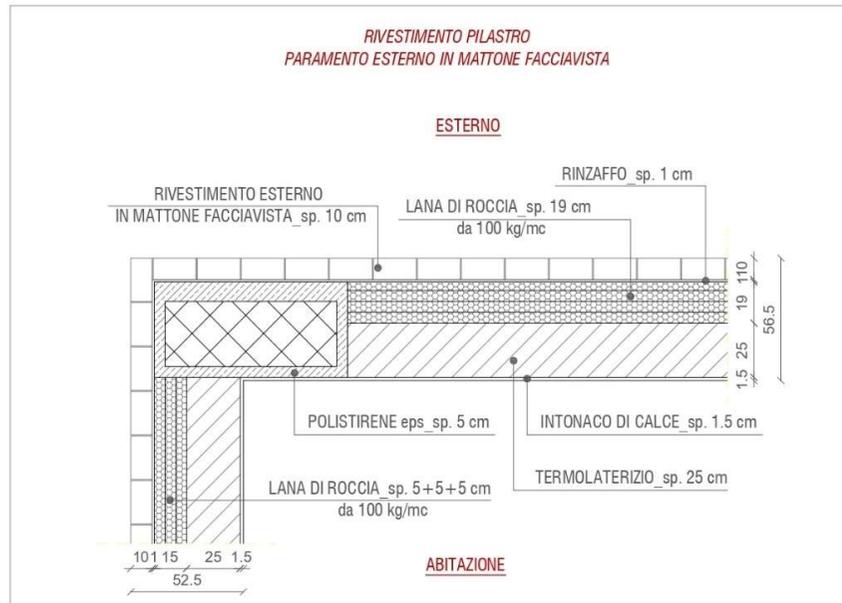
Stratigrafia muratura perimetrale con mattone a vista.
